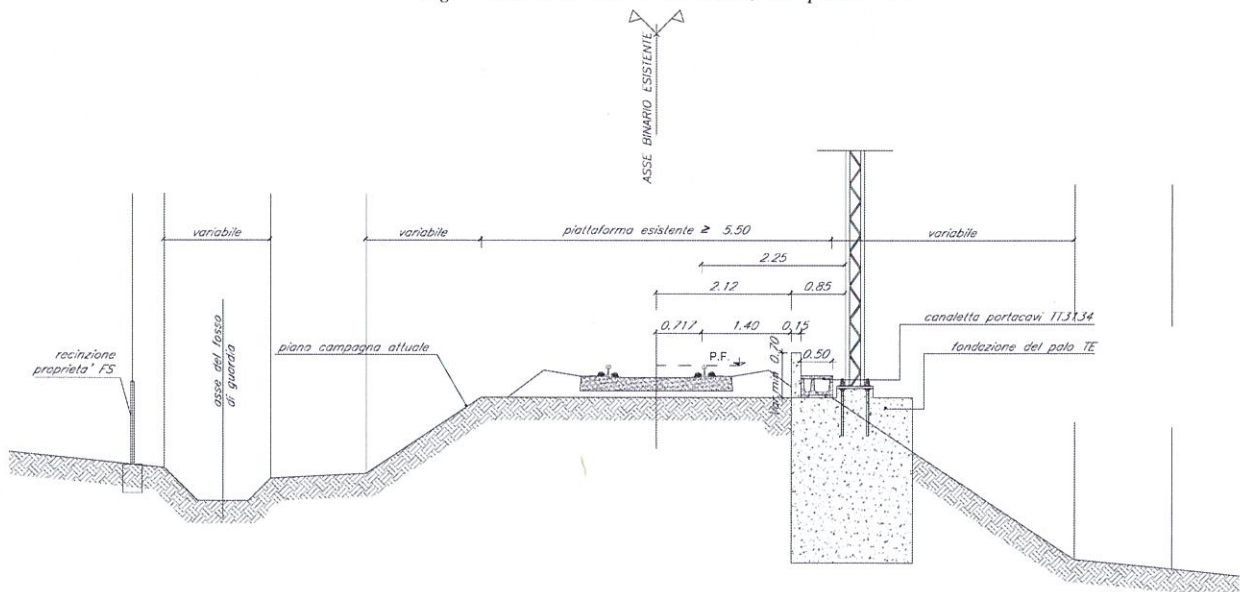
Tratta Cervaro - Candela. Sezione tipo in rilevato
